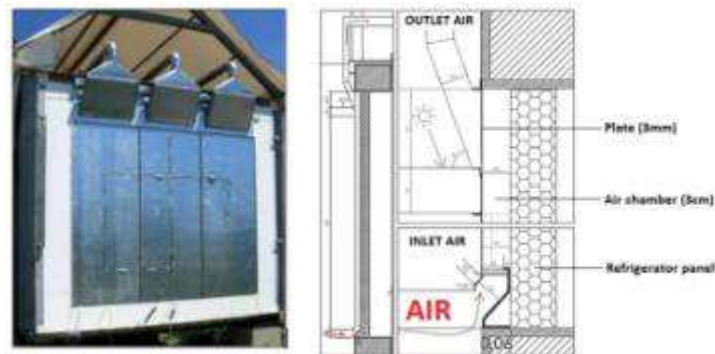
Fachada ligera opaca ventilada y su esquema constructivo
